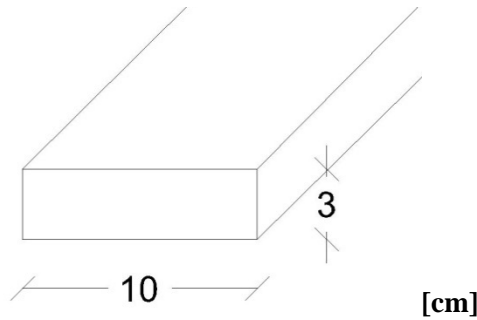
Secção transversal das ripas de madeira em cm.
